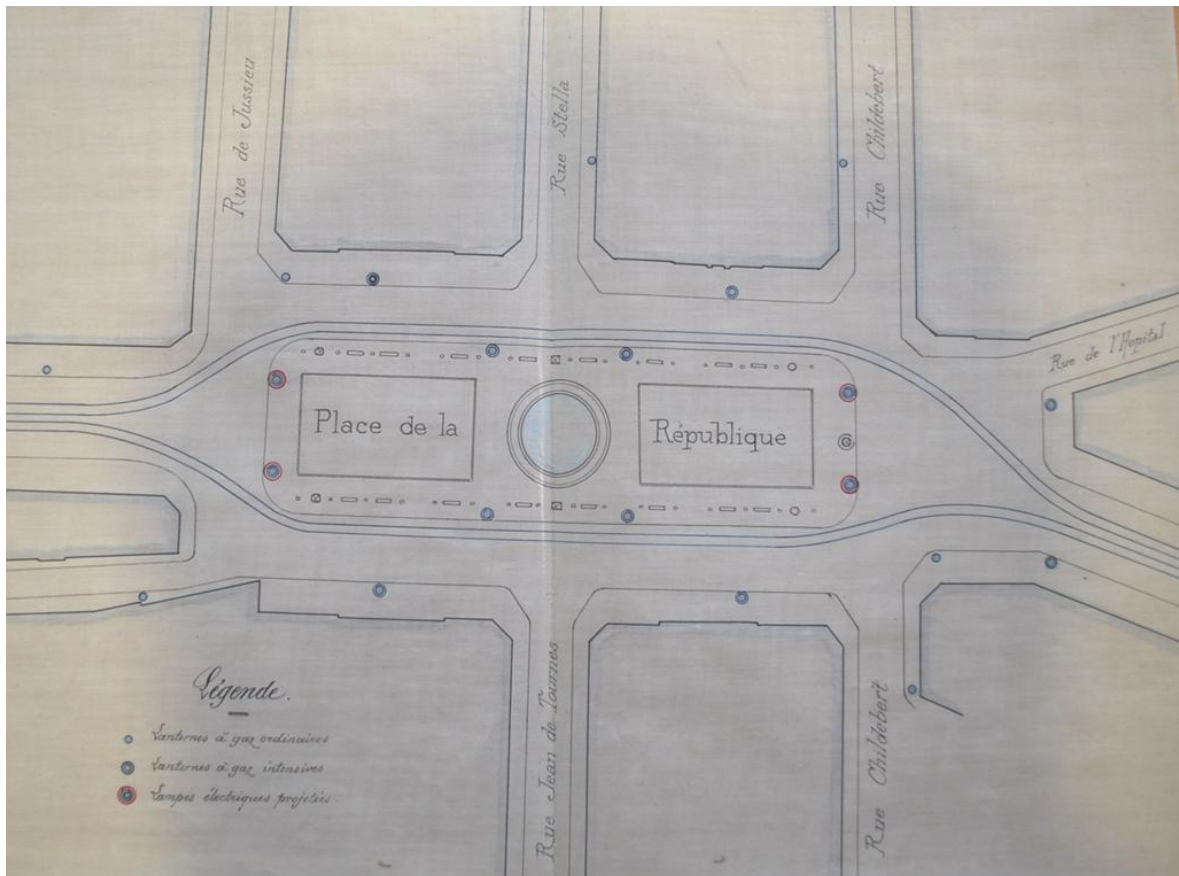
Plan de l'installation de l'éclairage électrique d'essai de la place de la République (A.M.L. 923 WP 193)
